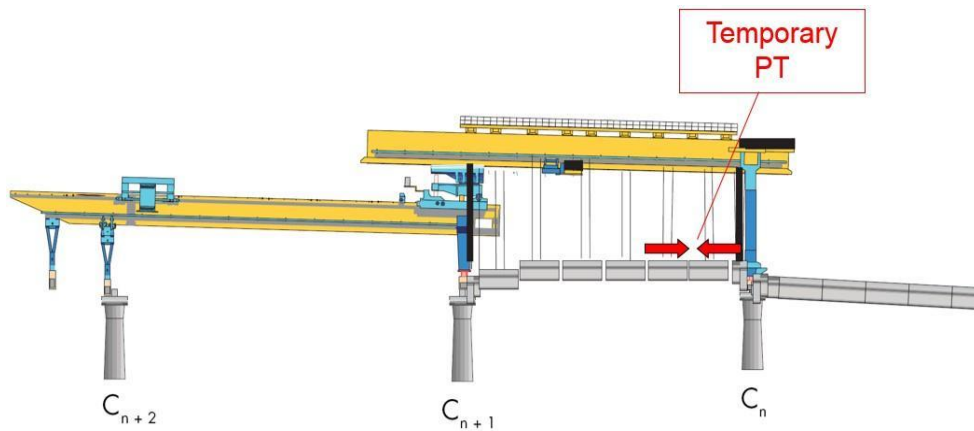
Aplicación del adhesivo epóxico y tesado de barras temporales
